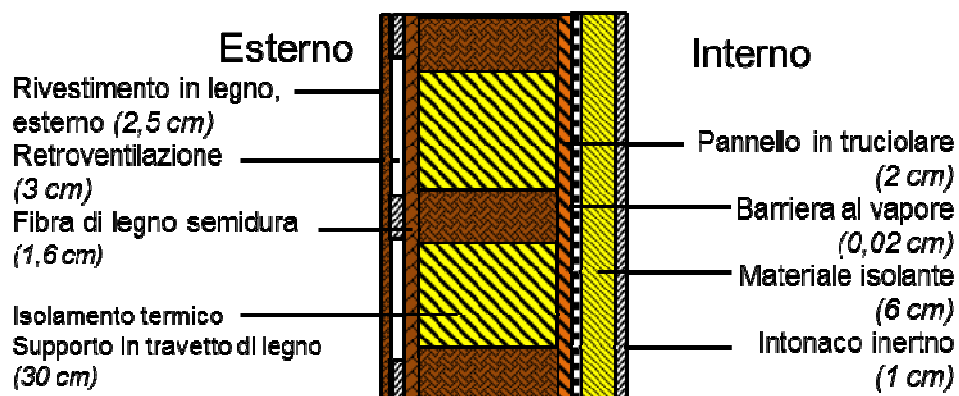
Struttura di parete esterna di casa passiva con struttura a telaio in legno (estate 2011)
